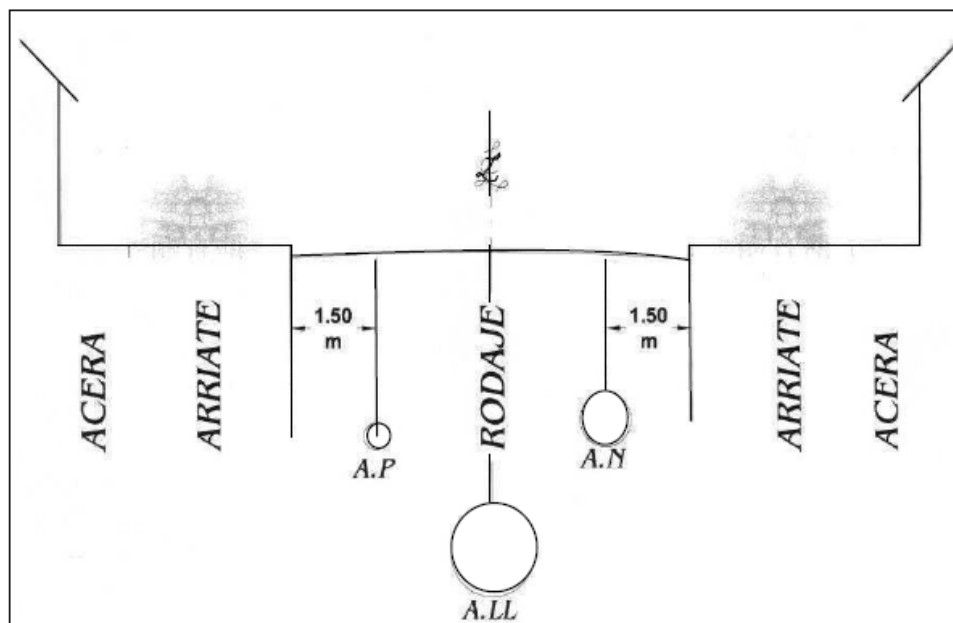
Detalle típico de ubicación de tuberías en un derecho de vía. Fuente: Detalle típico de ubicación de tuberías en un derecho de vía
